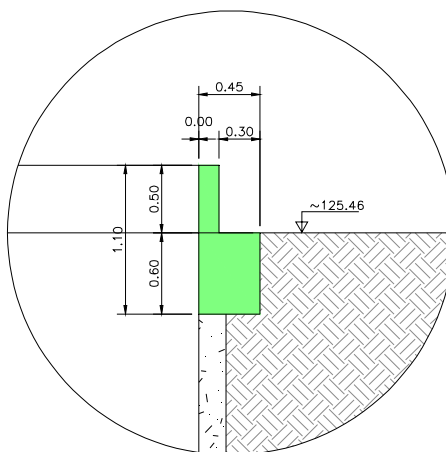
Geometria da Viga de Bordadura – Poço de Ventilação
